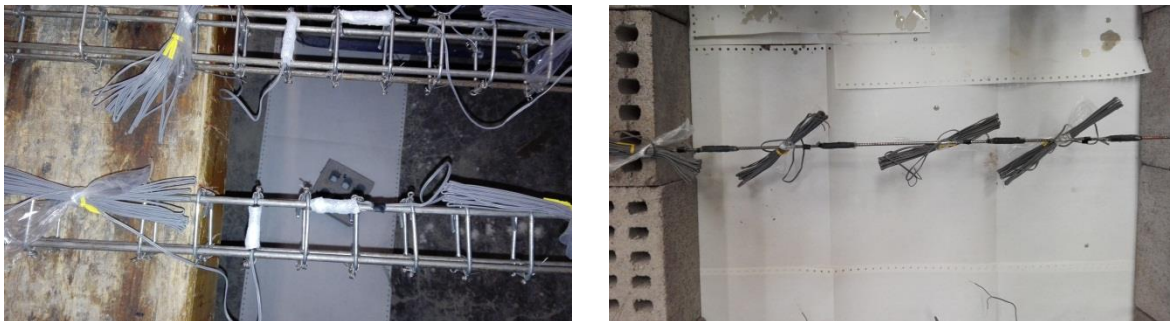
Instrumentación interna (castillo y refuerzo horizontal).
